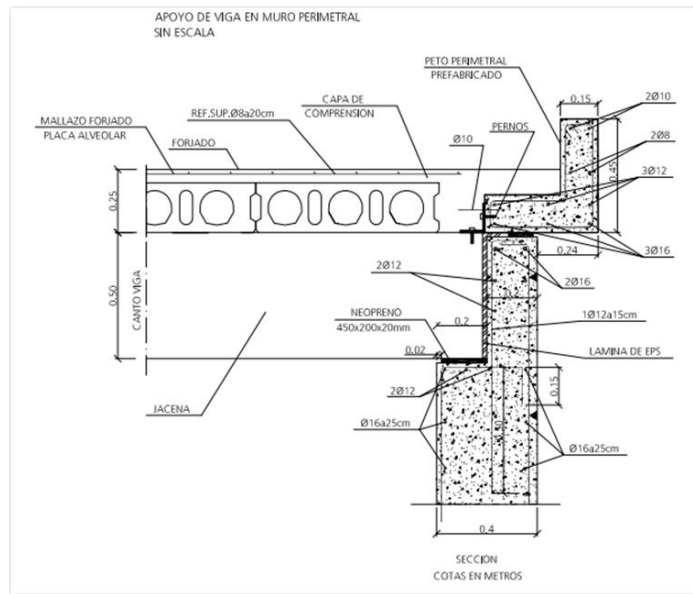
Detalle de apoyo de forjado en muro perimetral
